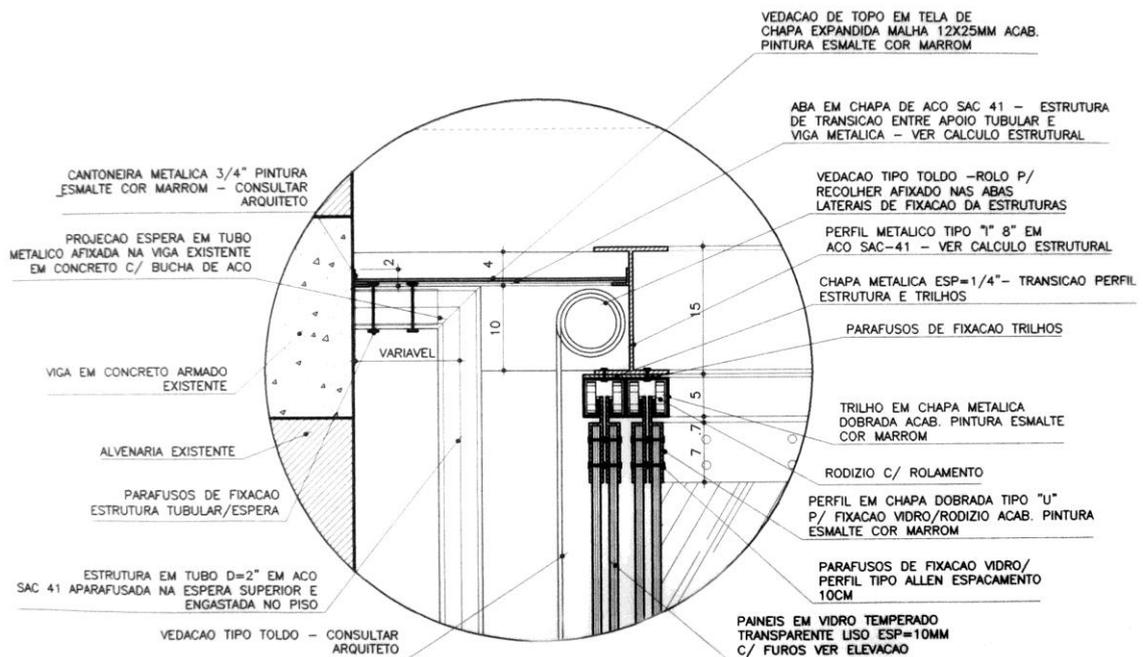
Foto digital de detalhe do encontro da subestrutura do painel de vidro e a cinta de concreto existente - detalhe como é mostrado nas pranchas de detalhamento.
